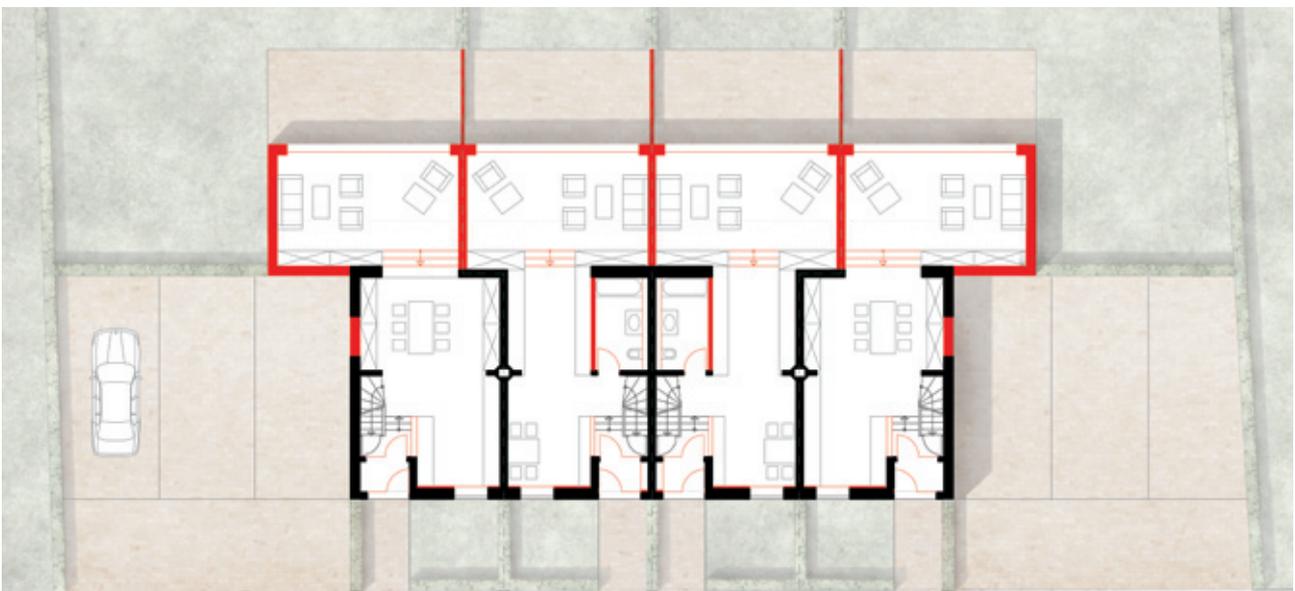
Grundriss Erdgeschoss Hausgruppe Variante II
